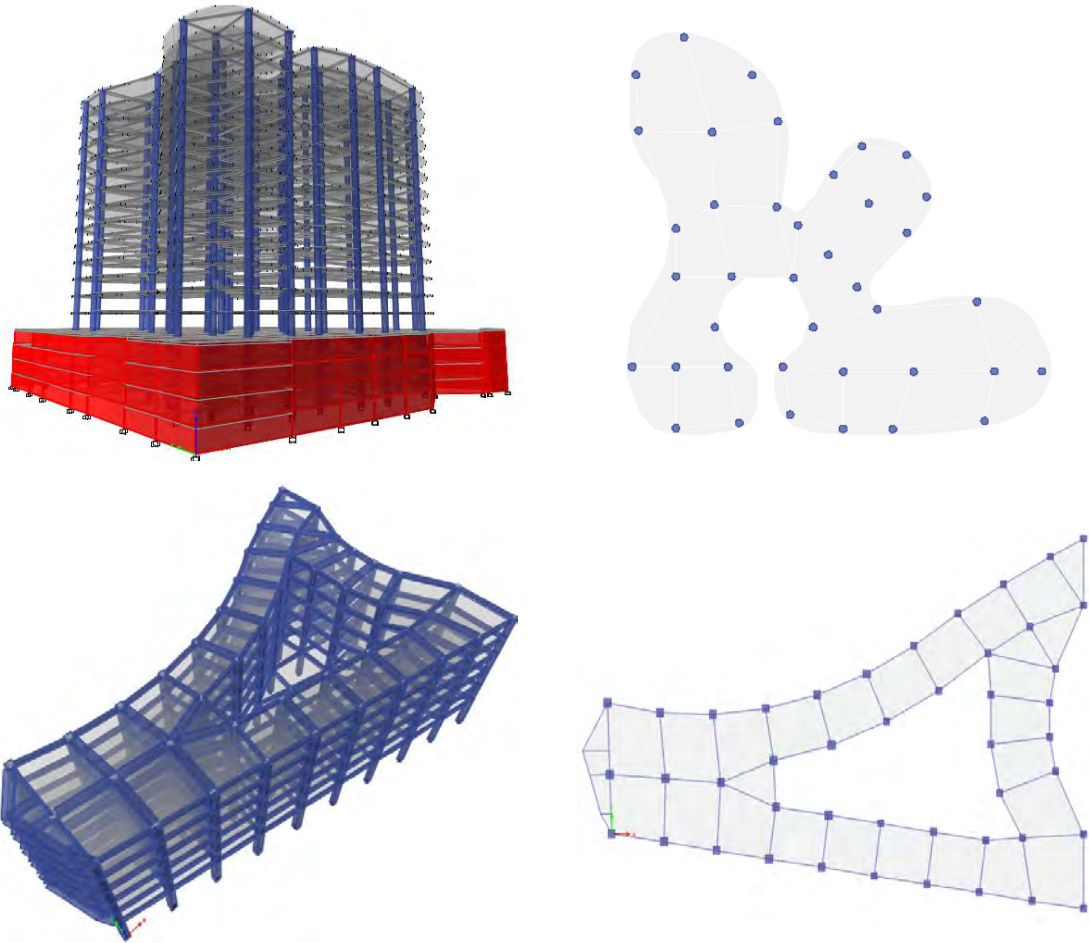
Diafragma rígido v/s flexible, en modelos estructurales con irregularidad en planta
